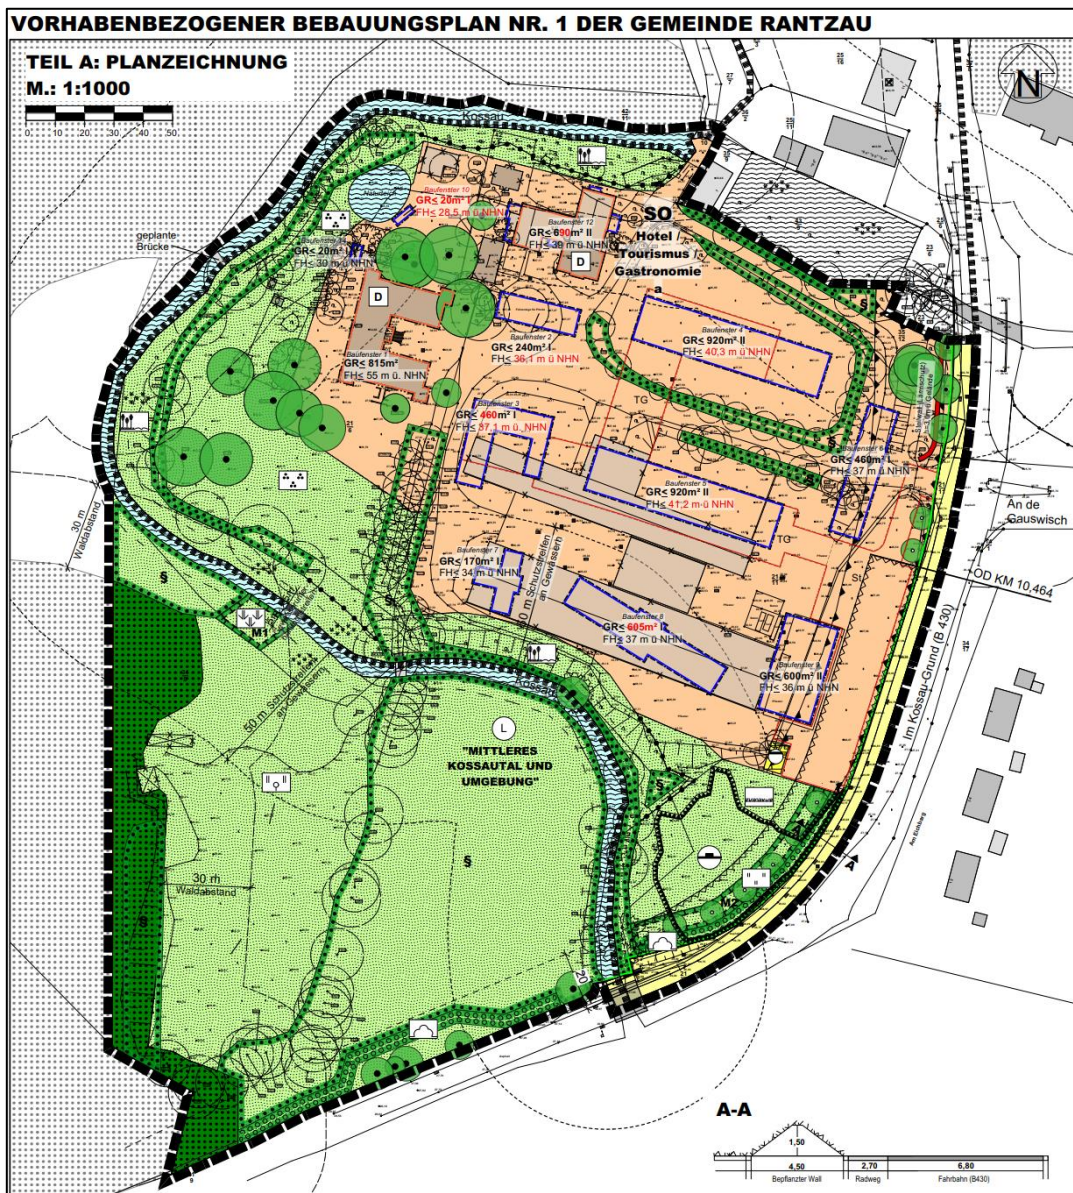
Planzeichnung, Vorentwurf B-Plan (PLOH, Stand 10.10.2023)
